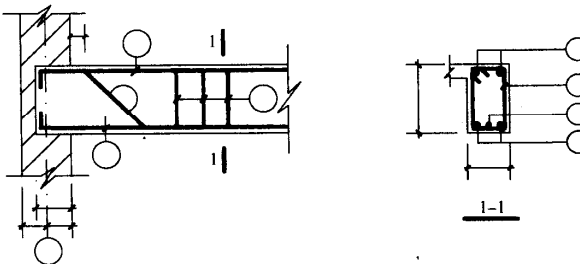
梁纵、横断面图中钢筋表示方法
